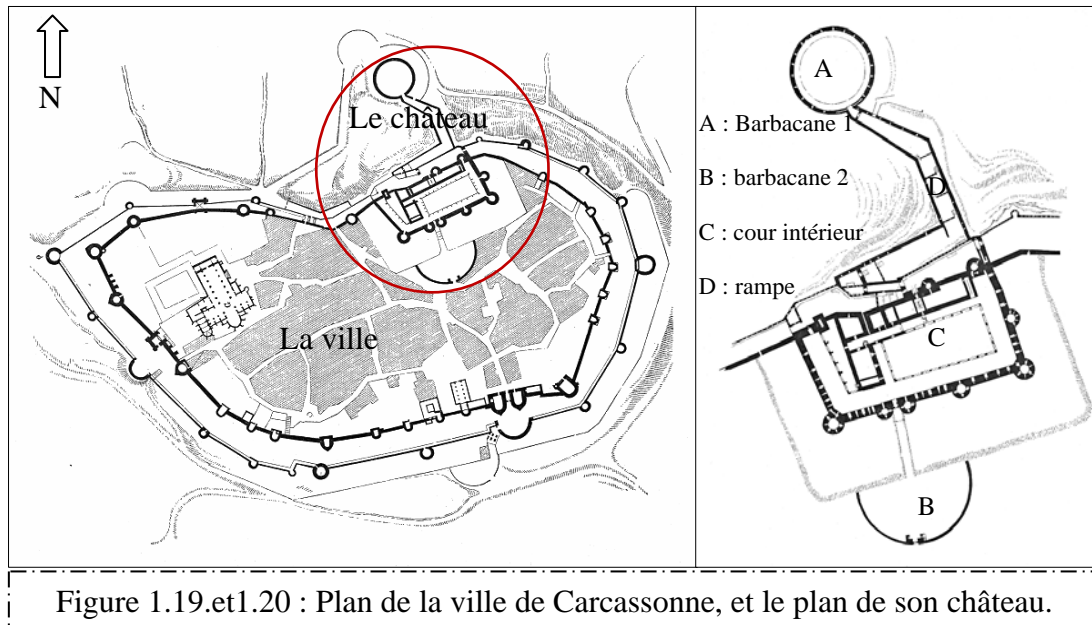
et1.20 : Plan de la ville de Carcassonne, et le plan de son château.
